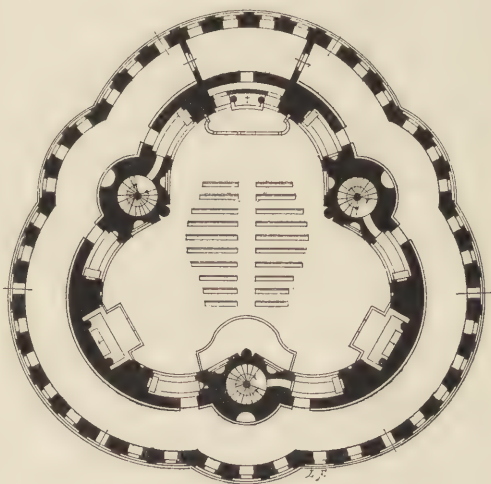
Dreifaltigkeitskapelle bei Waldsassen. Grundriss.
